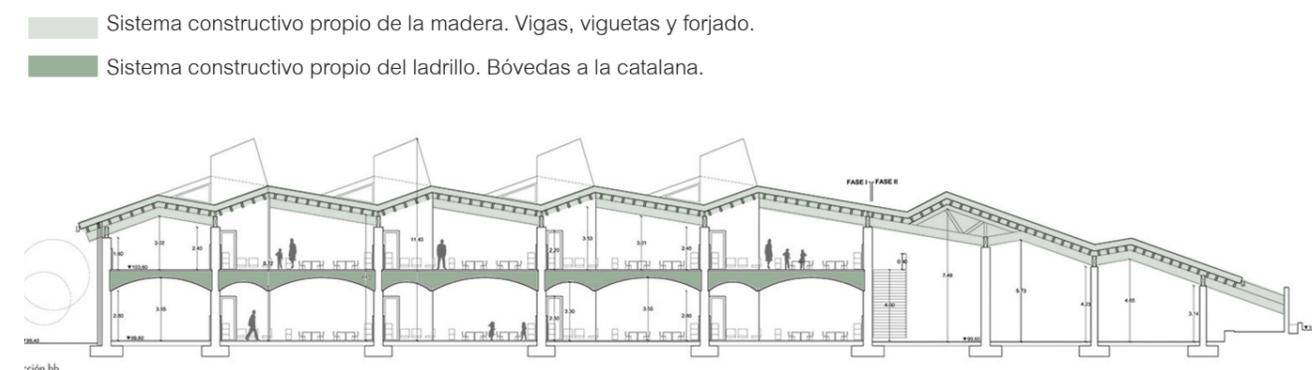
Sección del proyecto donde se aprecian los distintos sistemas constructivos empleados en función del material utilizado.
